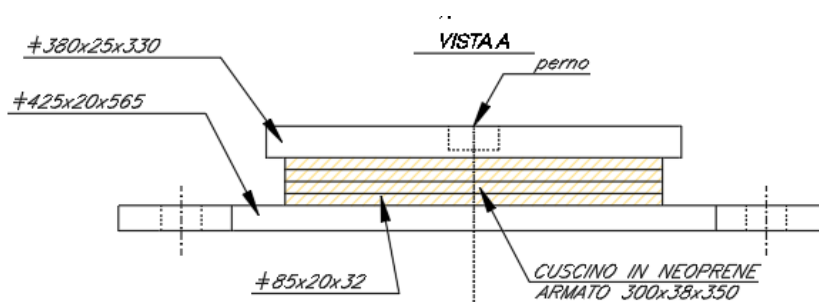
Dispositivi di appoggio multidirezionale – Sezione longitudinale
